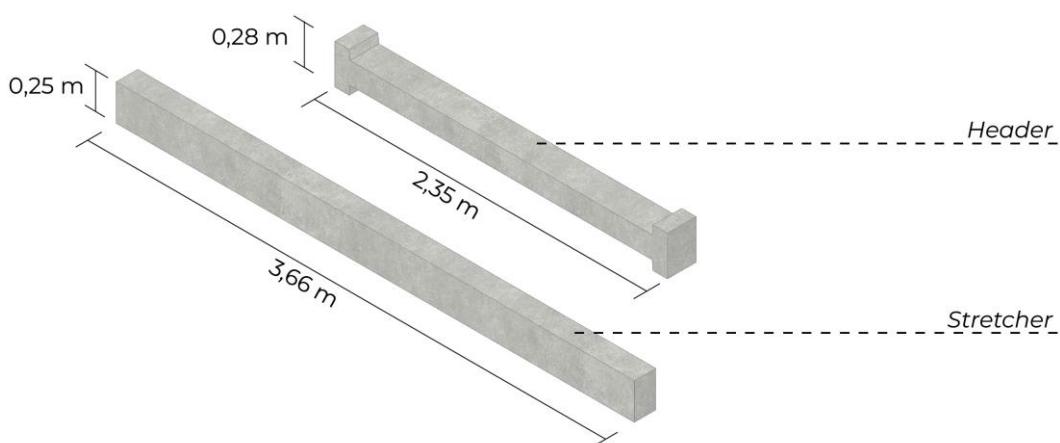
Peças modulares do *Crib-Wall* (*header* e *stretcher*)
